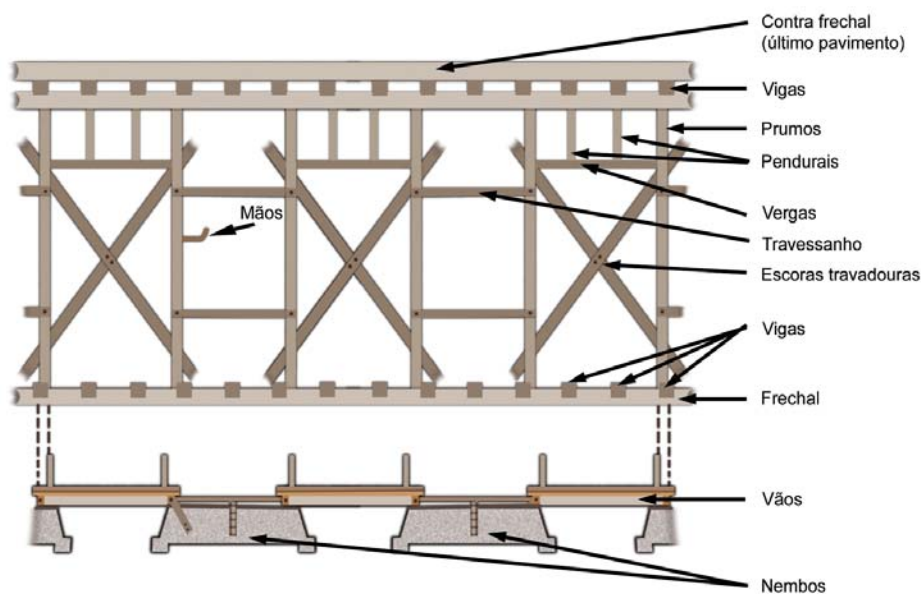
Em construções mais antigas encontram-se paredes e divisórias com armações de madeira.
